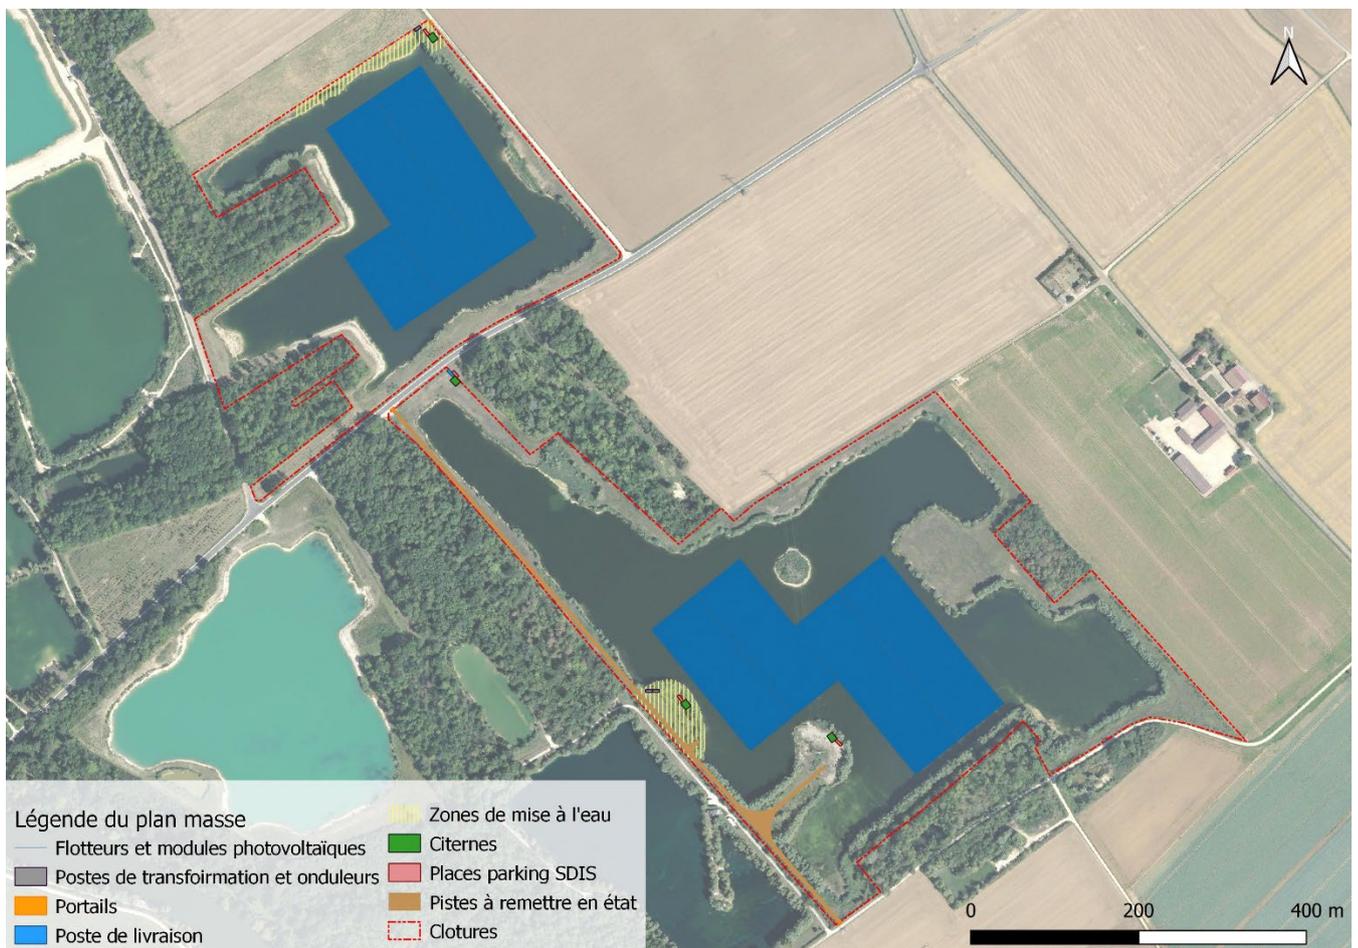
Plan masse du projet de centrale photovoltaïque flottante
